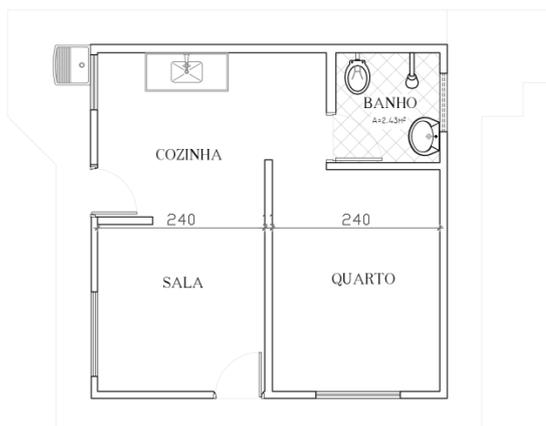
Planta Baixa do Conjunto Ulisses Guimarães. Fonte: Autora, 2019
